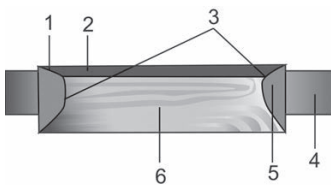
Расположение брусков в оконном проеме: 1 — паз коробки; 2 — четверть; 3 — боковые бруски коробки; 4 — бревно; 5 — заглушина; 6 — подоконник
